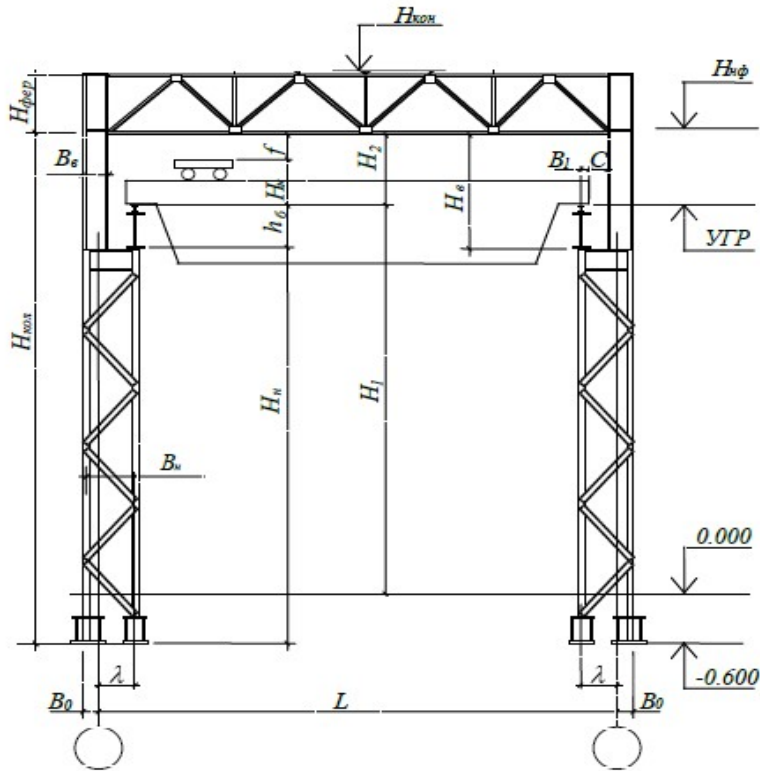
Схема каркаса поперечной рамы одноэтажного промышленного здания
